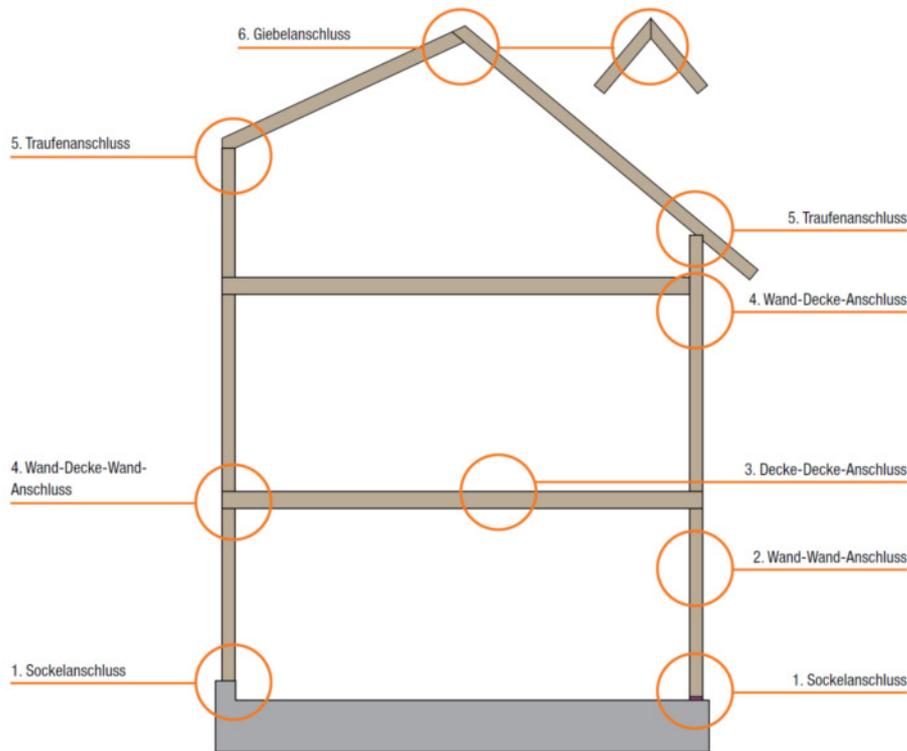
Anschlussbereiche in Hochbauten in der Brettsperrholz-Bauweise ¹⁵⁴
